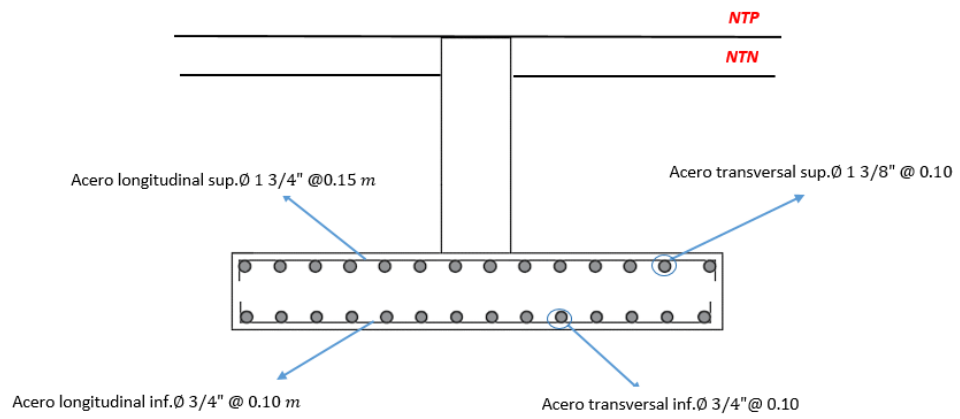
36. Detalle de la losa de cimentación para edificio de 15 pisos
